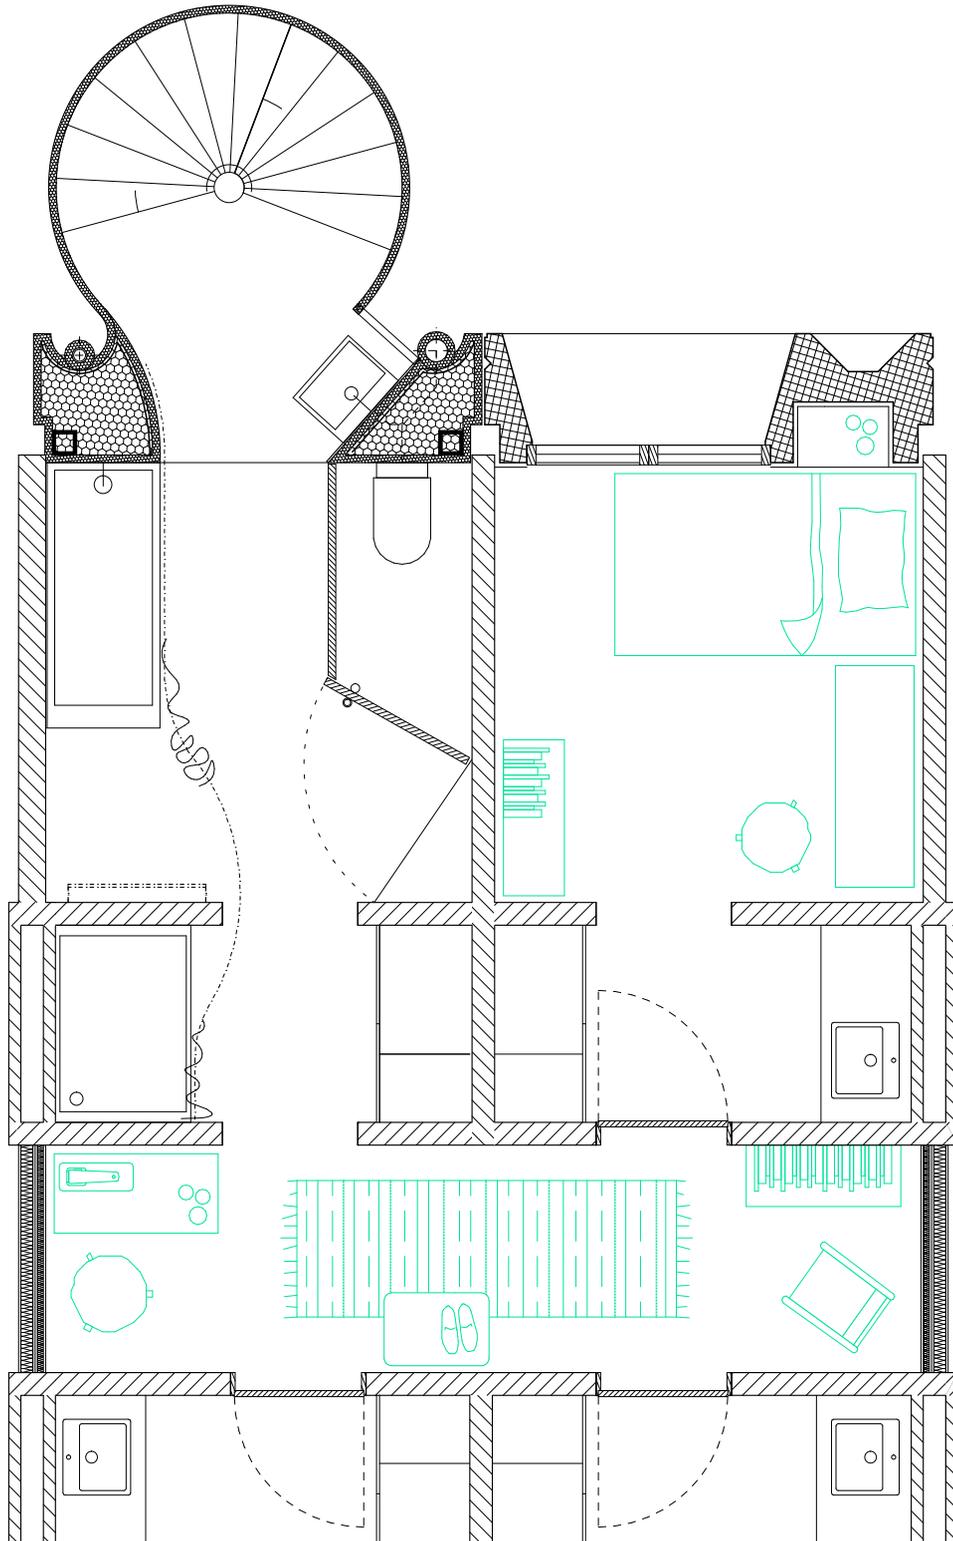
Ausschnitt aus einer Wohnung mit dem neuen Fassadenelement
